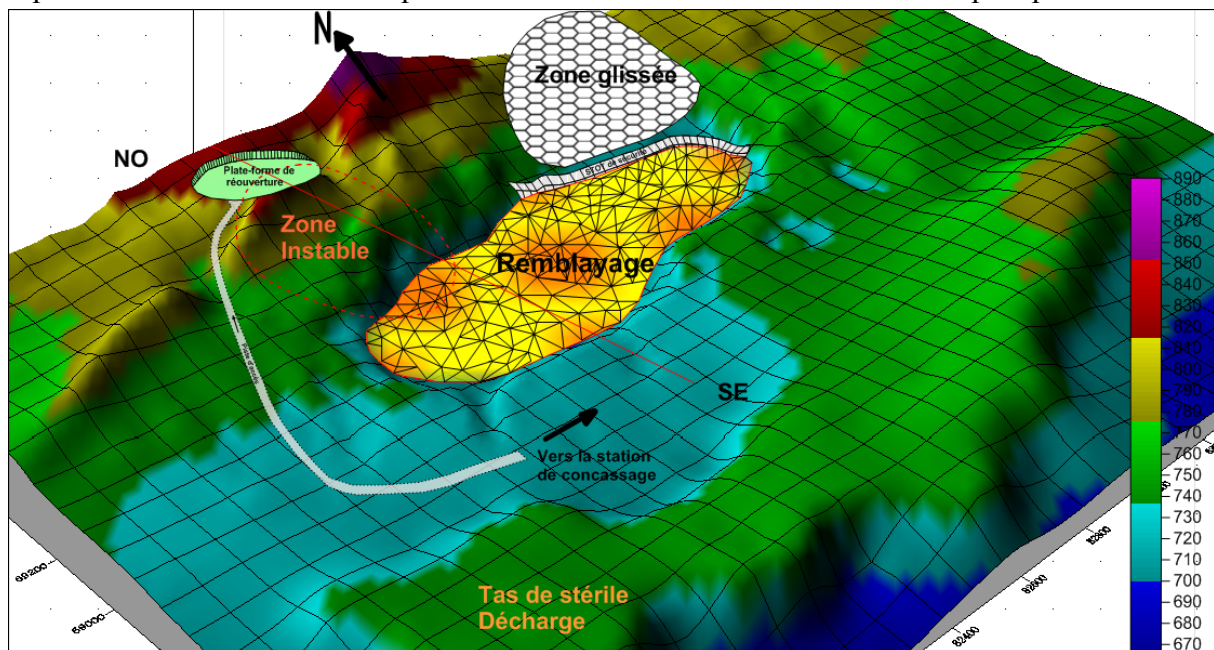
VI: État de la carrière après le remblayage et l'ouverture de la plateforme initiale
